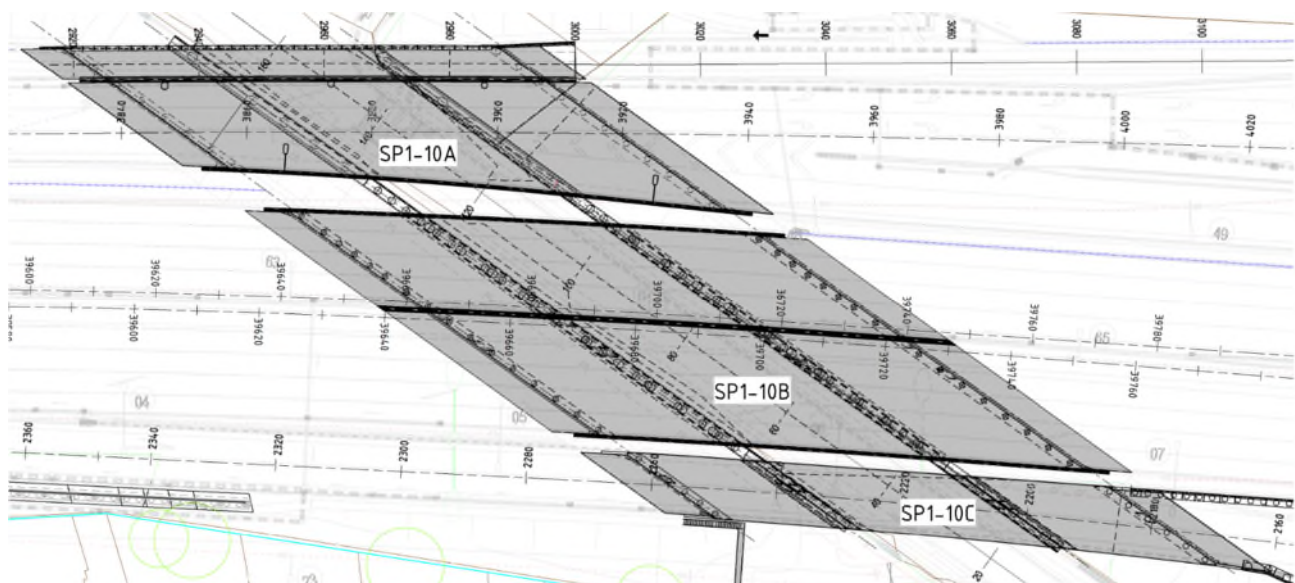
Vista en planta de los puentes sobre Kempston Street.
